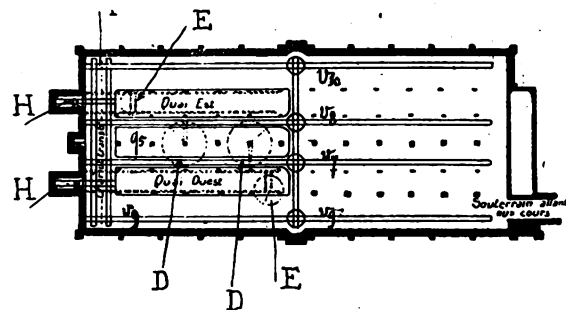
Plan du sous-sol de la gare de New Bridge street, à Newcastle.
